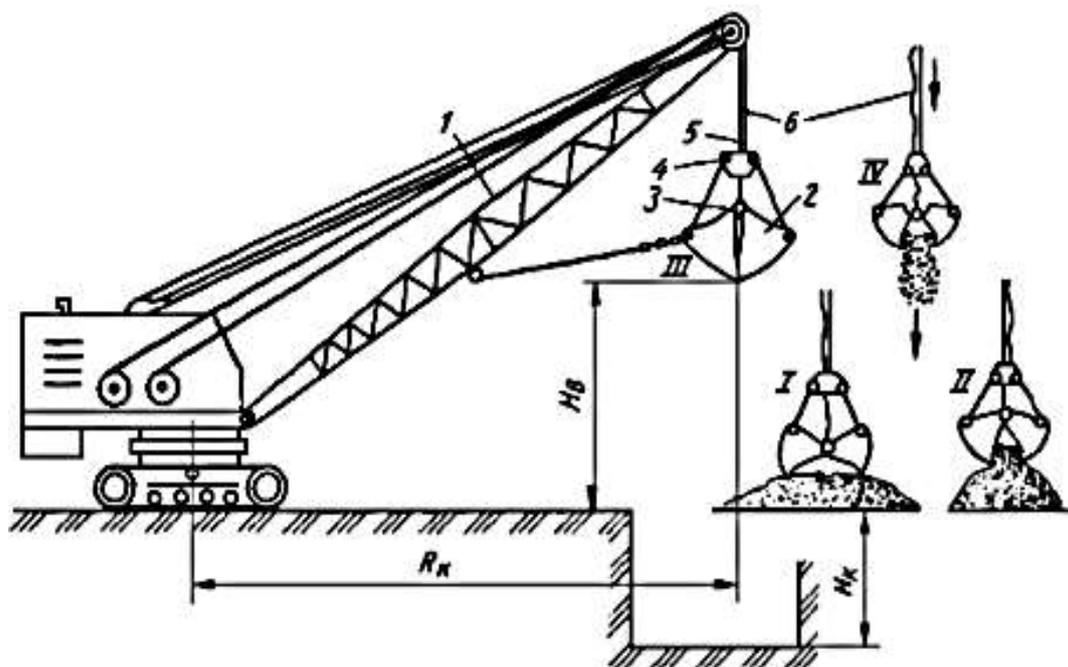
Рабочий процесс Экскаваторс рабочим оборудованием грейфера гибкой подвеской.
